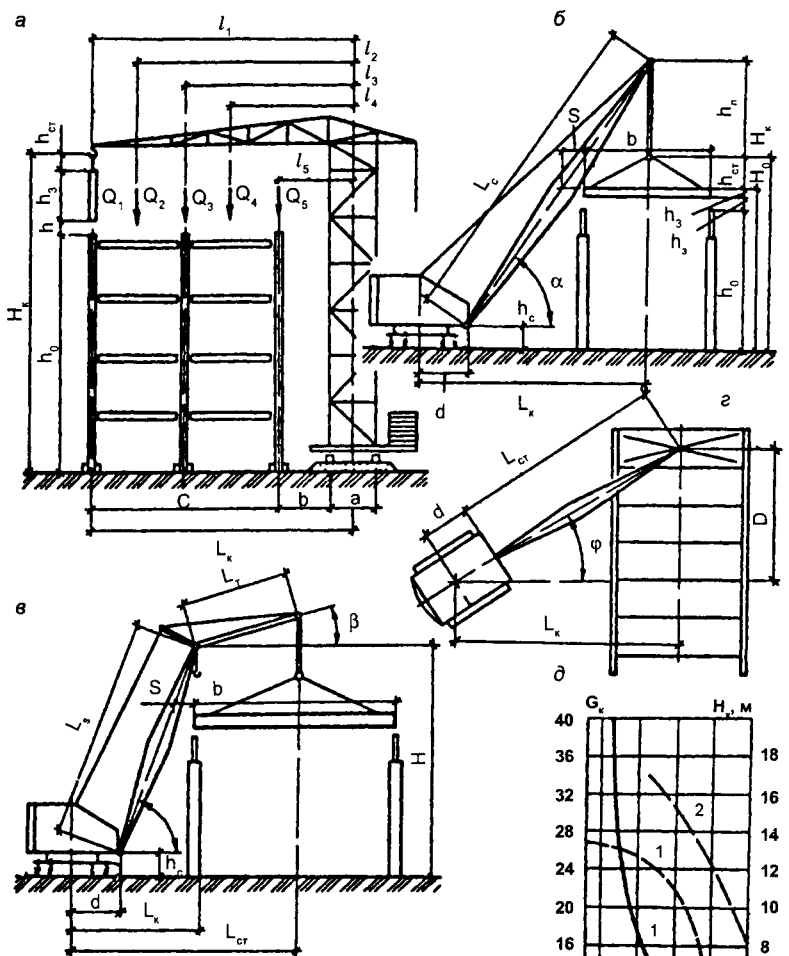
К определению параметров при выборе монтажных кранов при монтаже зданий:
